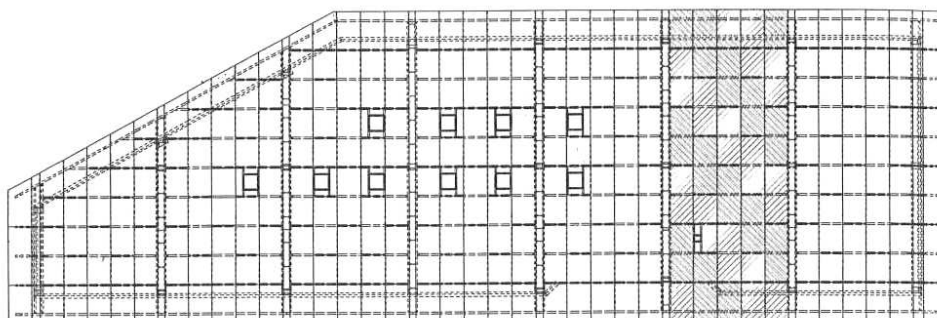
Controventi con pannelli di legno strutturale; pianta dei pannelli sfalsati.
